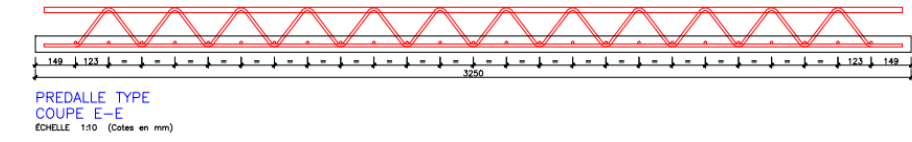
Coupe d'une prédalle type pour une travée de la passerelle
